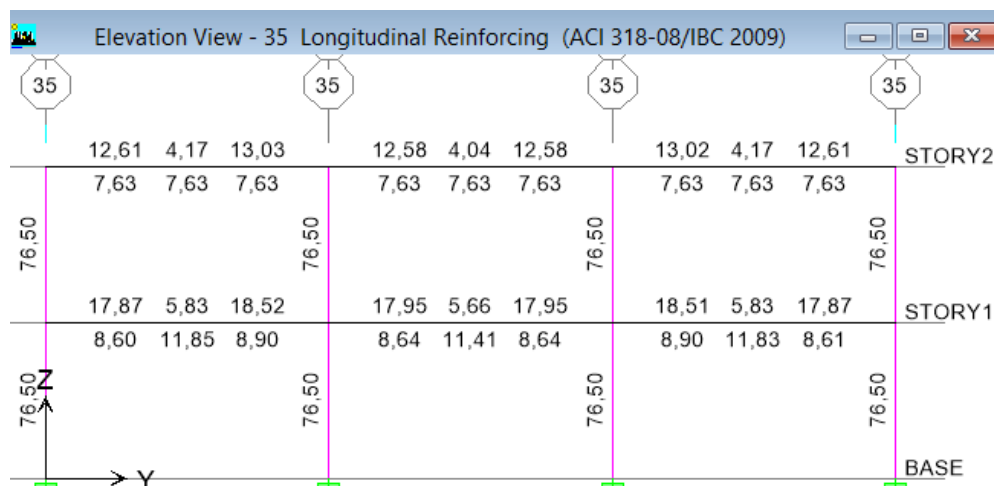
Acero en Vigas y Columnas en el Pórtico 35 – Obstetricia - (CEC2002)
